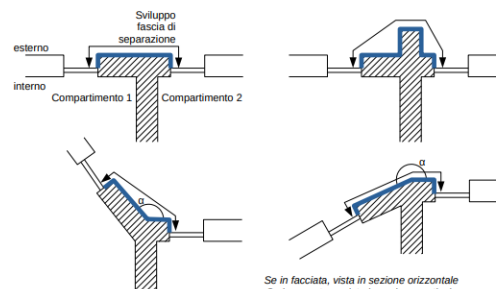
Esempi di fascia di separazione verticale in facciata o in copertura
